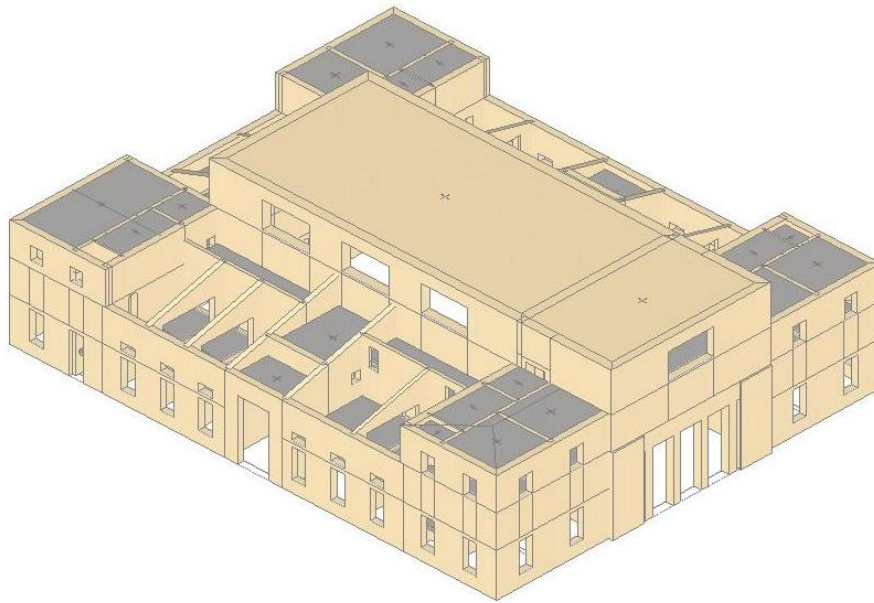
Vista tridimensionale - Prospetto ovest su via Beccaria e Prospetto nord su via Carmignani
